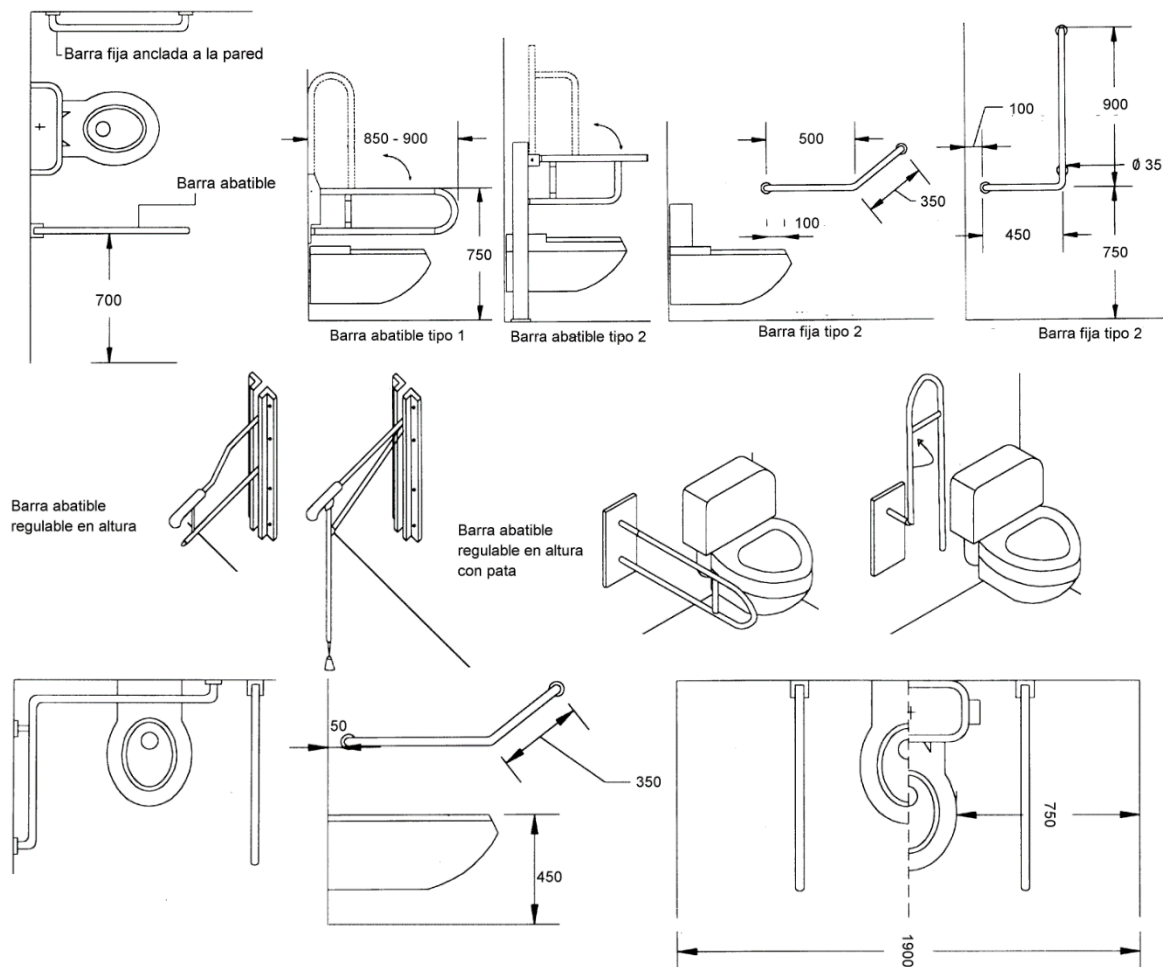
Barras de apoyo. Forma y disposición. Inodoro
